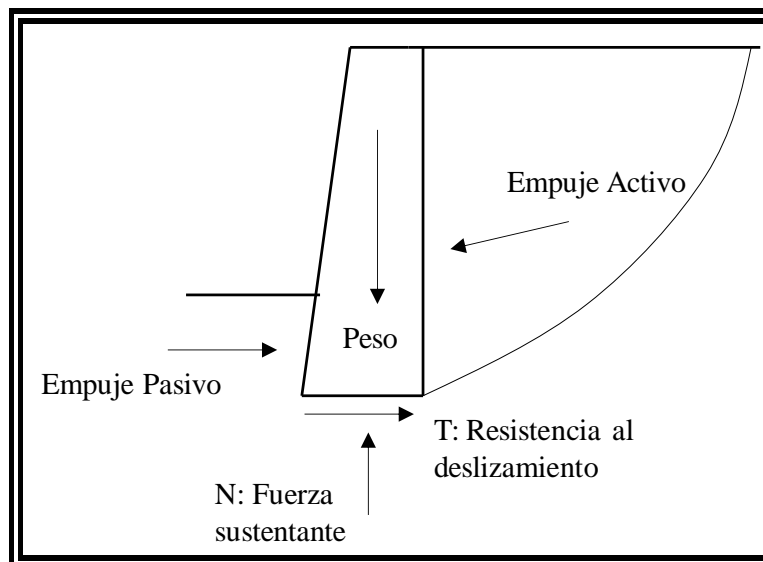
Esquema de empujes activo y pasivo sobre un muro de retención.
